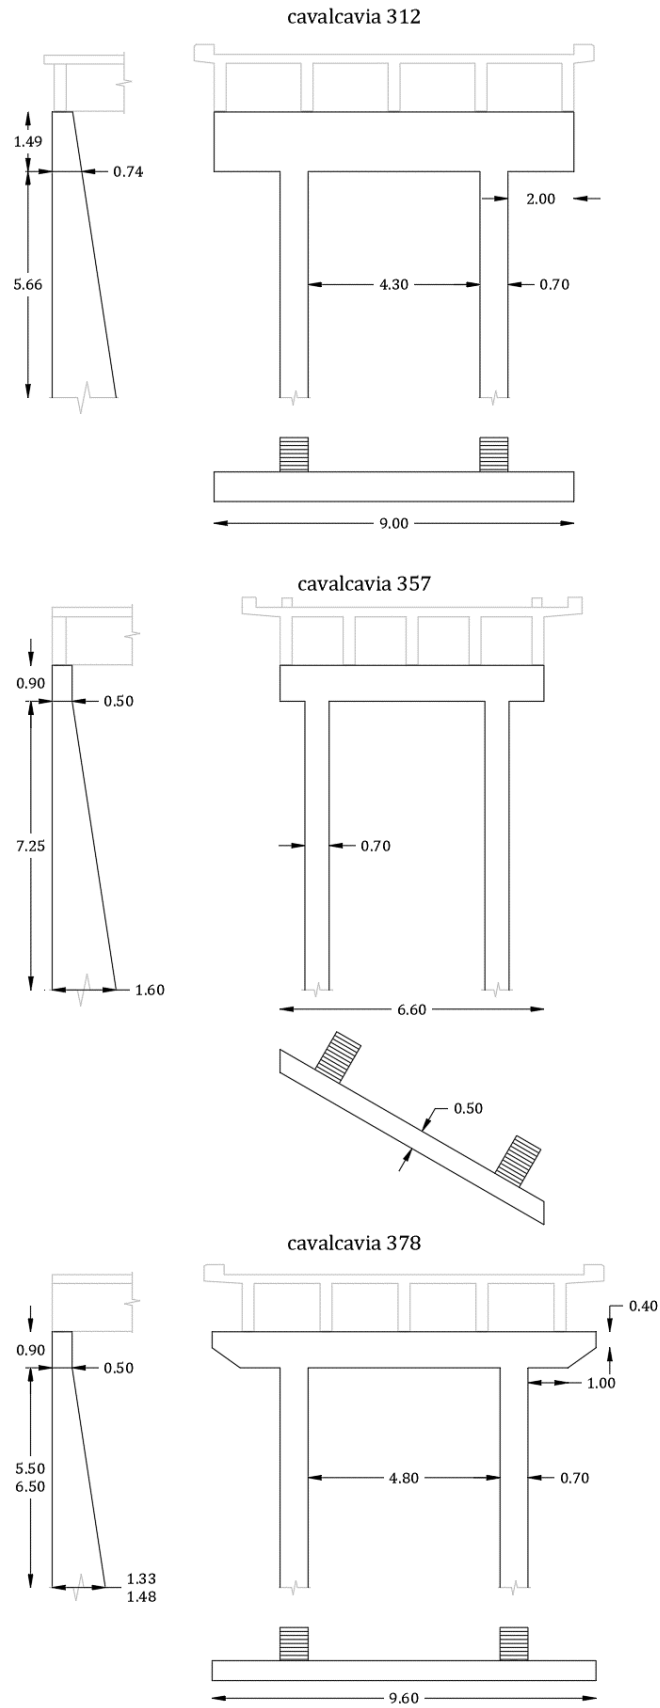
Sezione longitudinale e trasversale del sistema spalla
